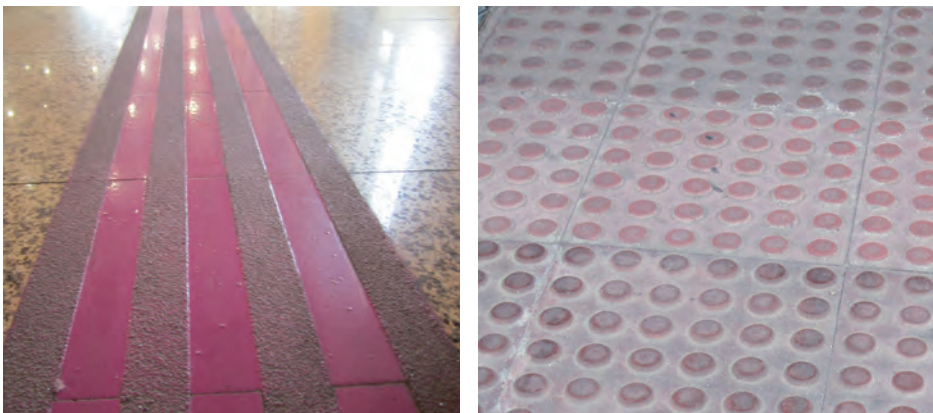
Imagen real de dos tipos de pavimentos táctiles.
